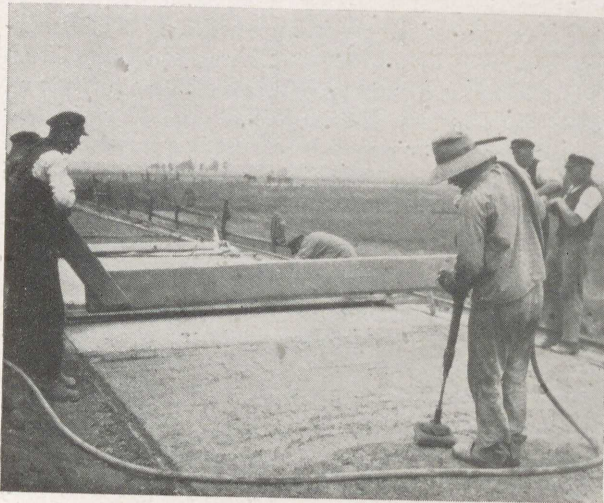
Preßluftstempfung des Unter- und Oberbetons. Handstampfbohle. Verreibung der Oberfläche von einer Arbeitsbrücke aus. Straße Altenwerder—Finkenwärder
